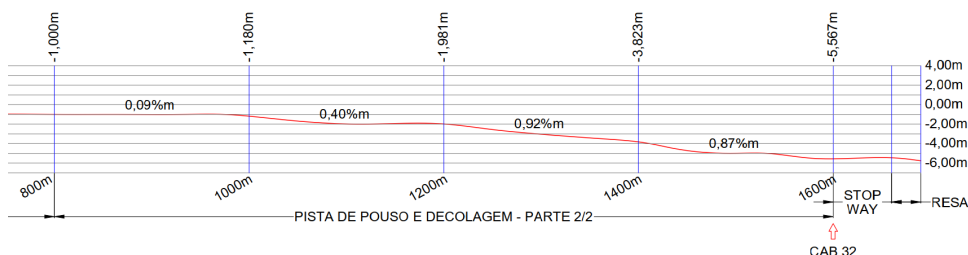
Perfil longitudinal do local escolhido para implantação da Pista de Pouso e Decolagem – Parte 2 de 2.
